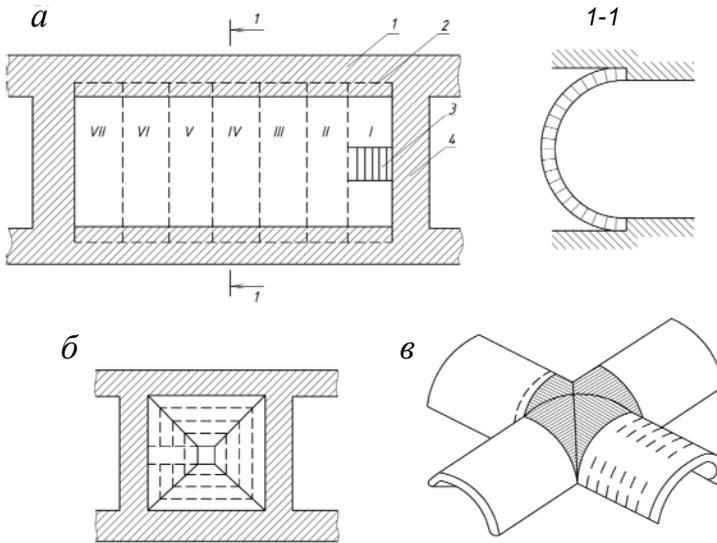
Схема разборки цилиндрического (а), сомкнутого (б) и крестового (в) сводов:
